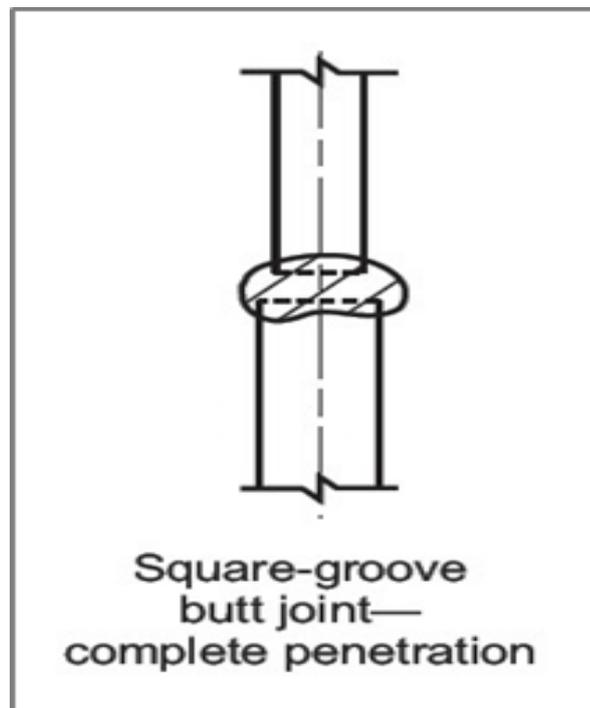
Soldaduras en junta vertical a tope
